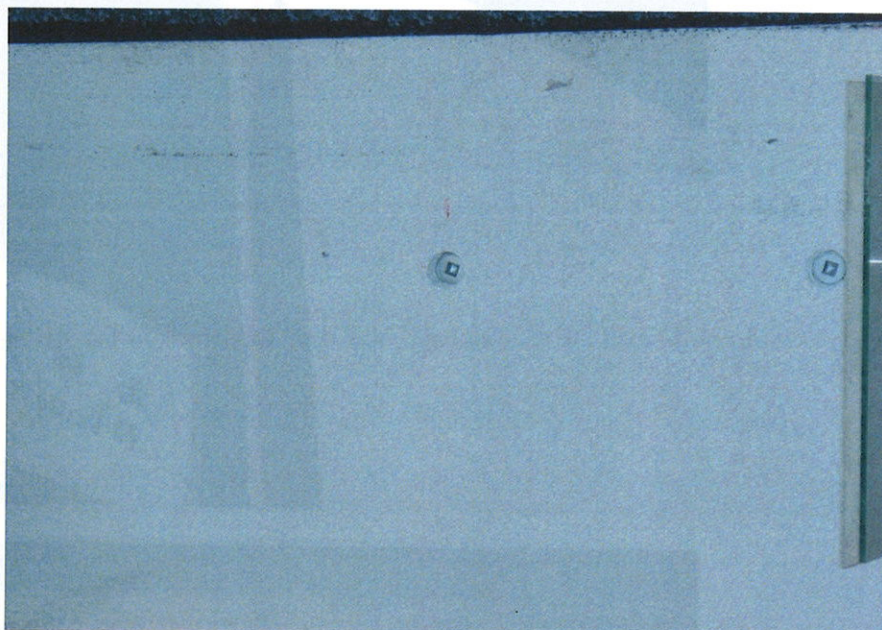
試験体の状況 (+1/100rad. : タッピンねじのめり込み)
